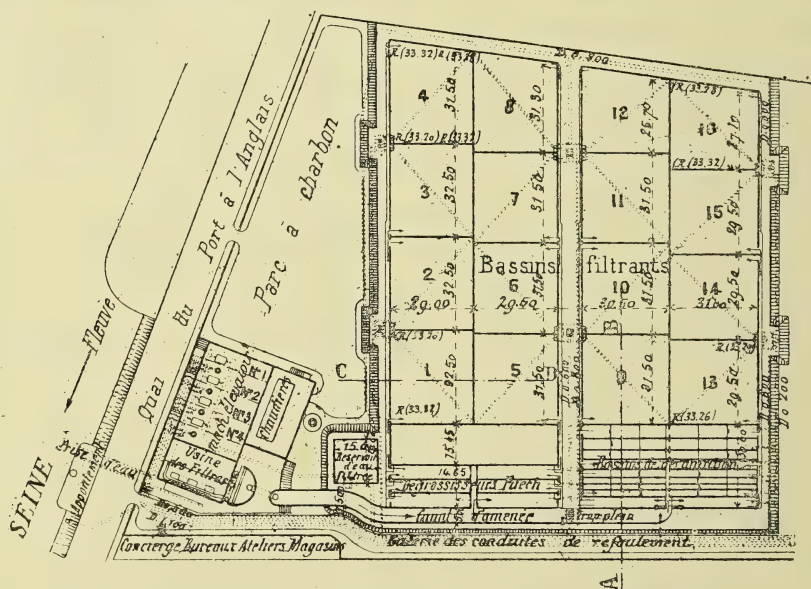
Établissement de filtrage d'Ivry. Plan général. (Imbeaux.)
